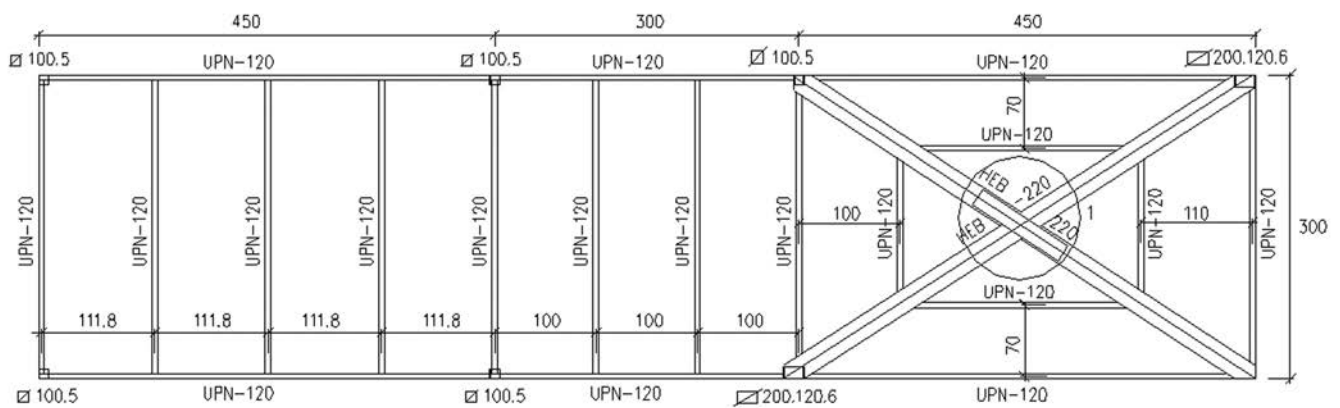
Plano de detalle de la estructura especial del porche exterior.
